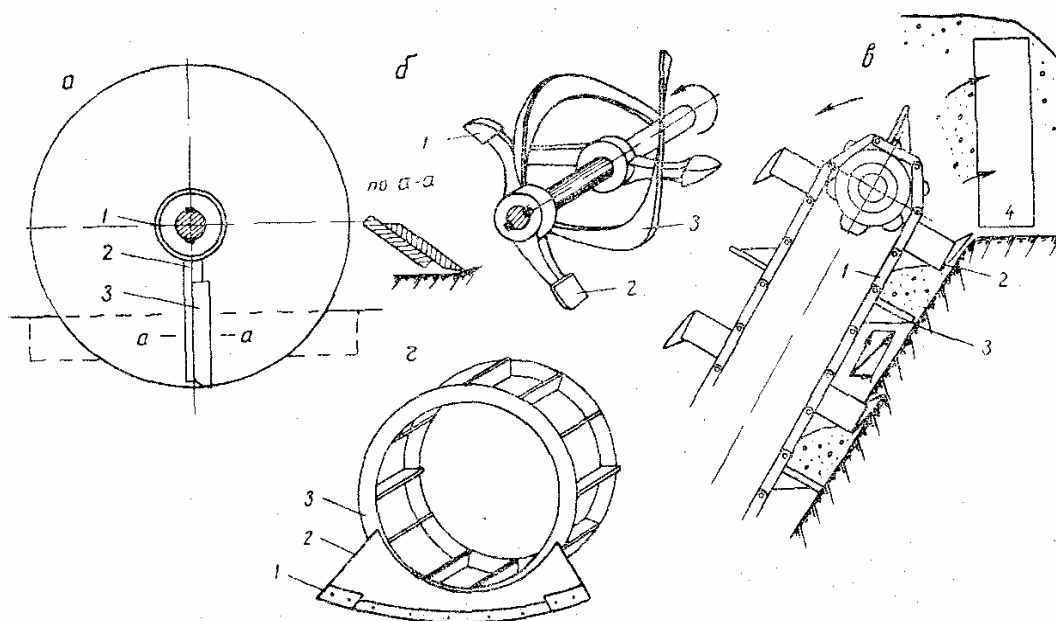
Схемы рабочих органов войсковых котлованных машин: а – фреза поперечного копания; б – фреза продольного копания; в – цепной; з – бульдозерный с активным отвалом.
